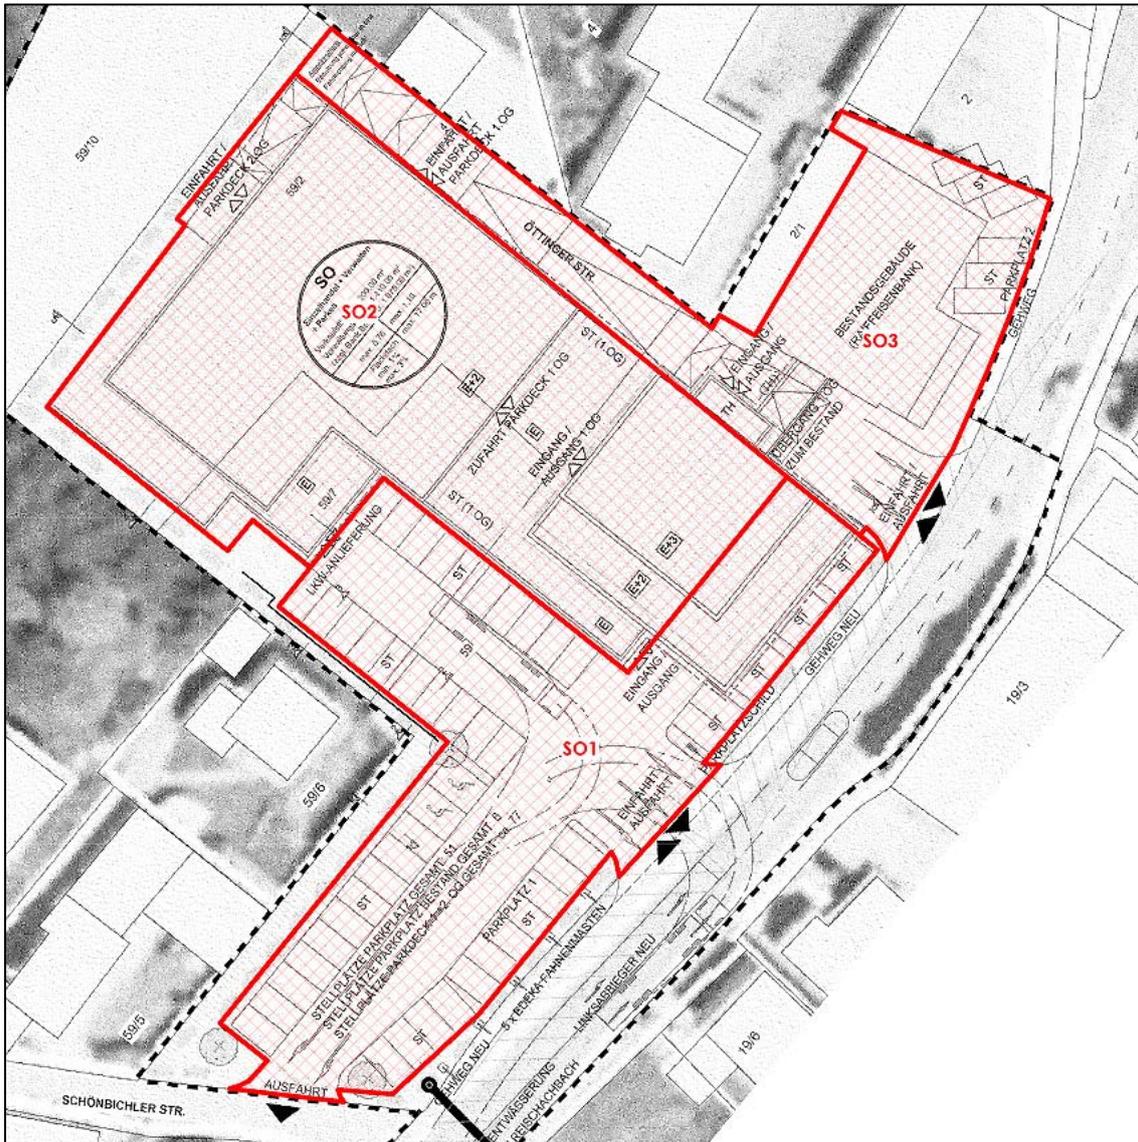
Lageplan mit Darstellung der gewählten Emissionsbezugsflächen SEK (M 1:750)
